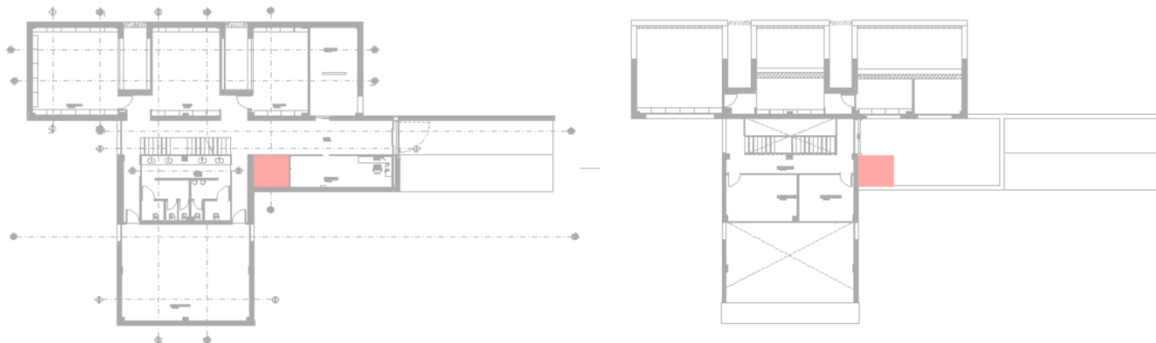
Zona donde se ubicará en un futuro el ascensor hidráulico tanto en planta baja como en planta primera
